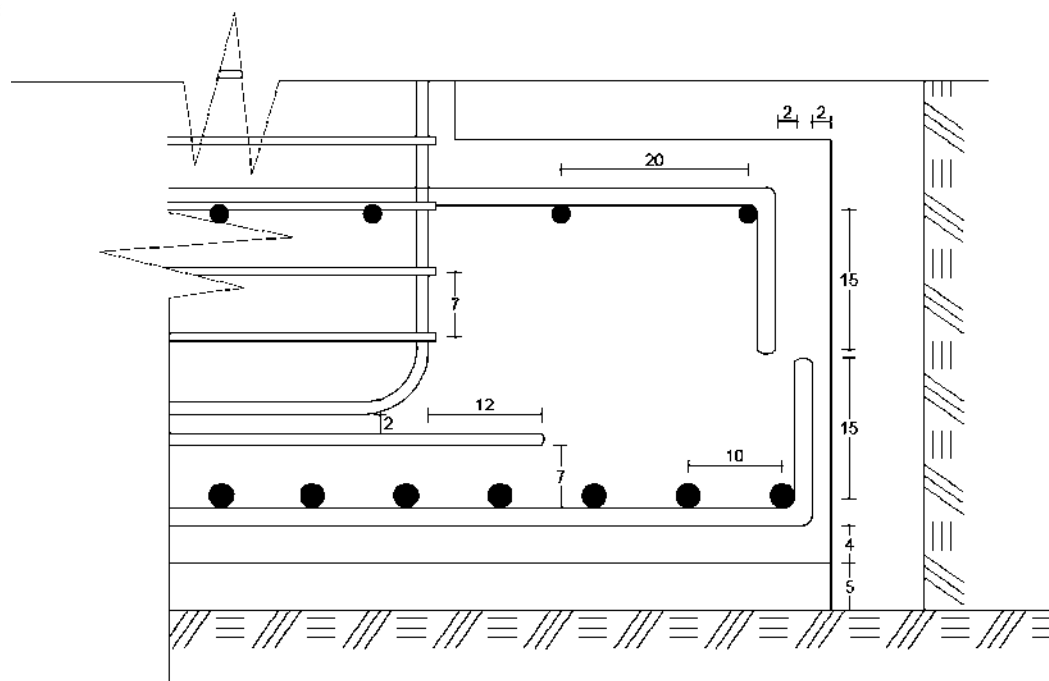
(d) Detallado de la zapata en dirección transversal de la estructura, (cm)
